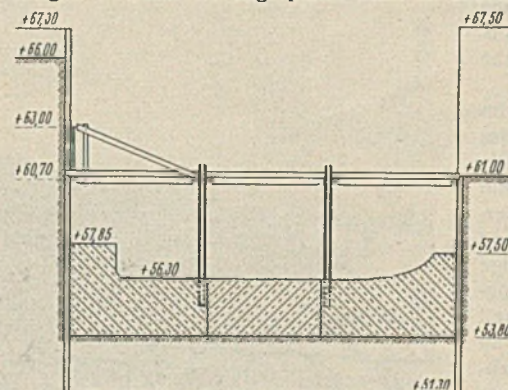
b. Aussteifung der Baugrube des Oberhauptes. Zweiter Bauzustand. Längsschnitt.
